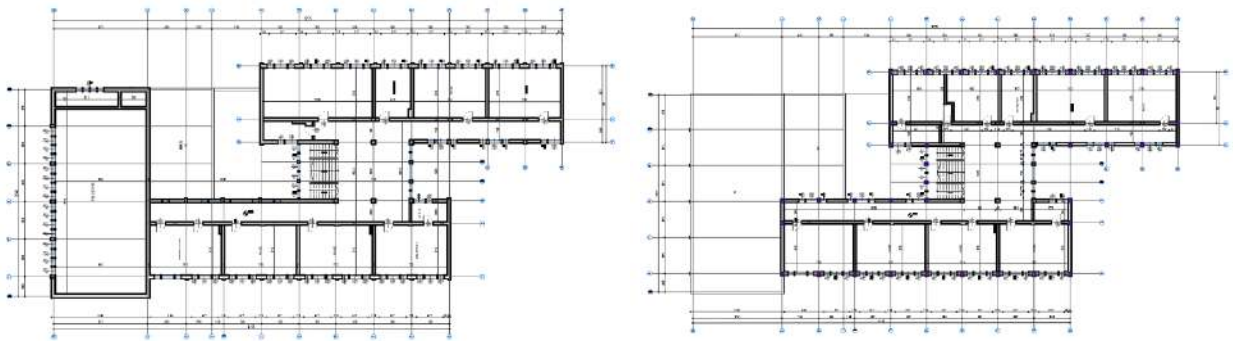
Planimetria e katit të pare dhe katit të dytë gjendja ekzistuese
